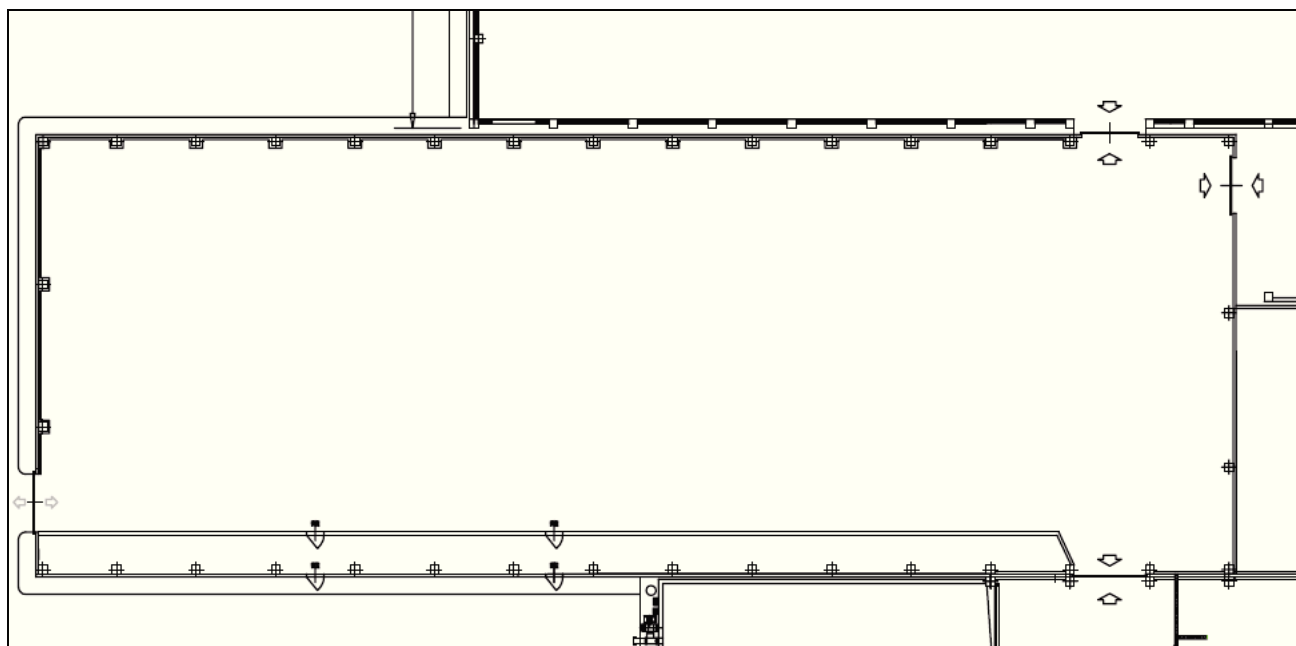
Stralcio progettuale dell'area di prima maturazione. L'edificio rimarrà immutato ad eccezione dell'apertura di collegamento con la zona delle nuove biocelle.
